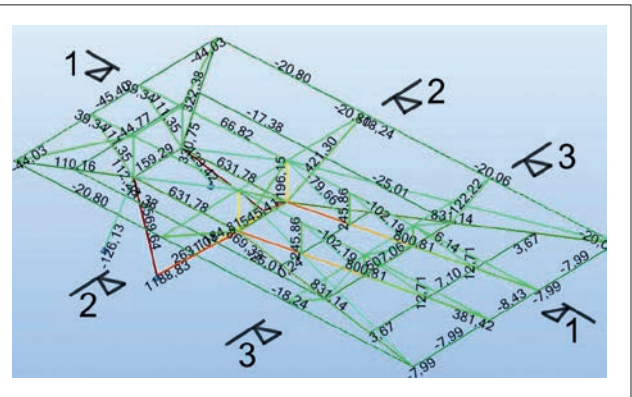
Konstrukcja nośna pojedynczego segmentu
